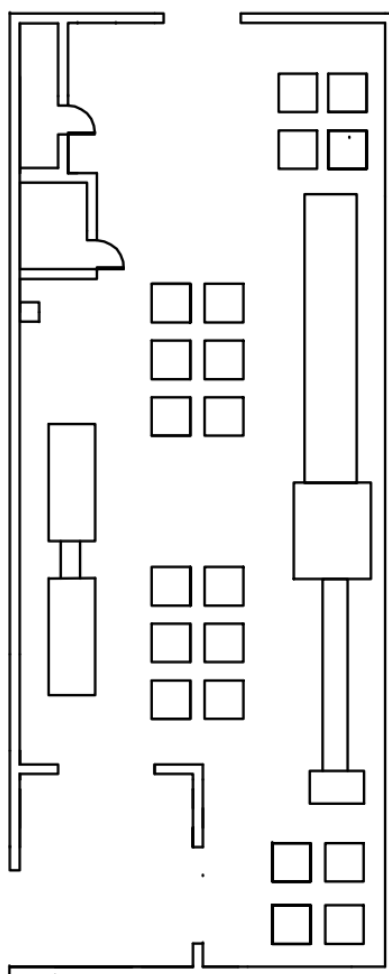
Lay out de la planta baja adaptado al terreno actual.
